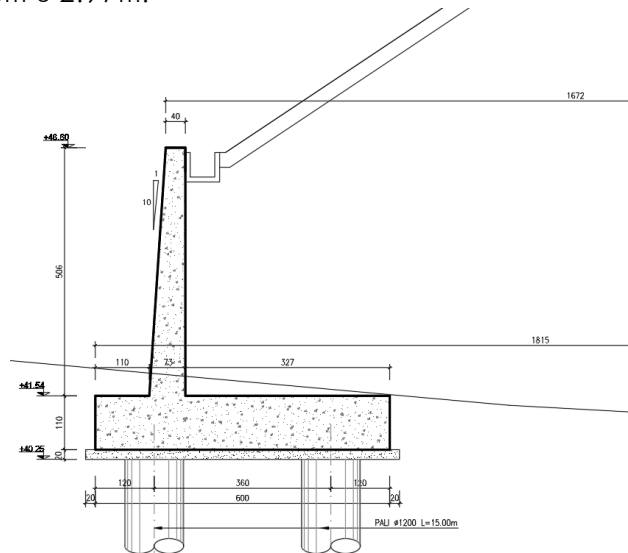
Sezione trasversale muro lato spalla A in sx
